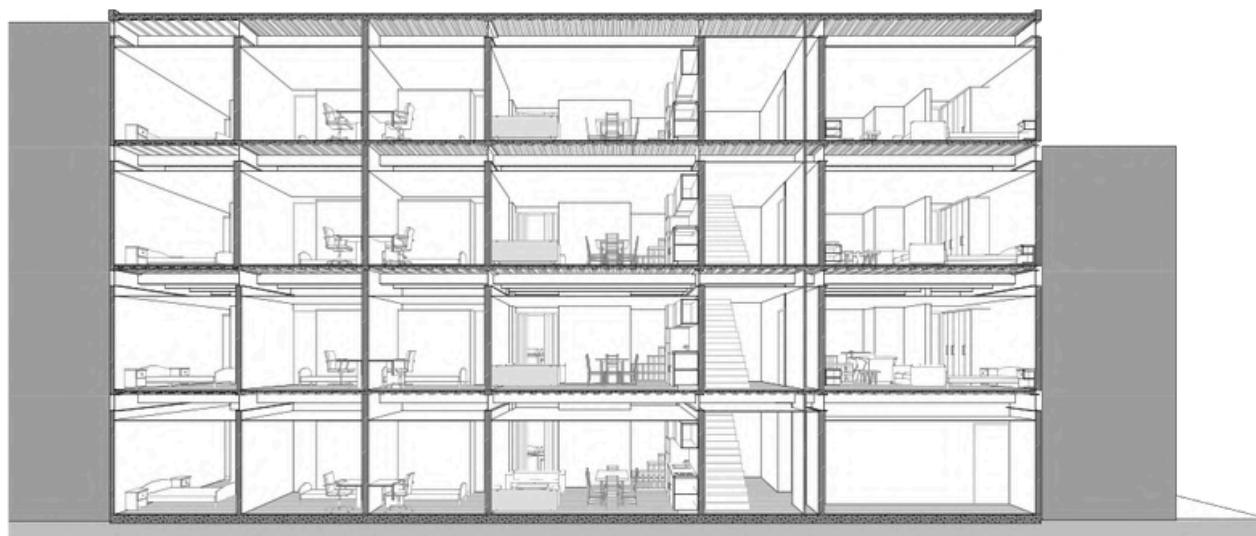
(sistema constructivo) 2026, Autoría propia.
